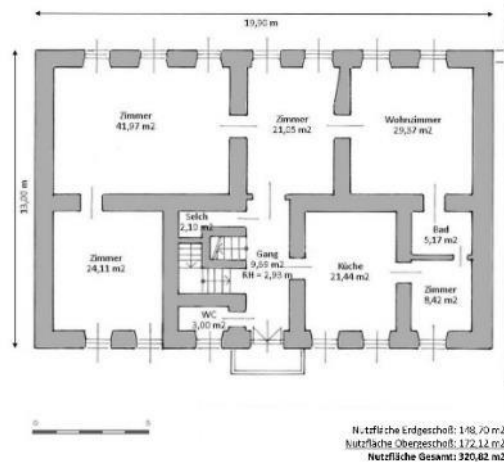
Grundriss Obergeschöß, Pfarrhaus Winden am See.
